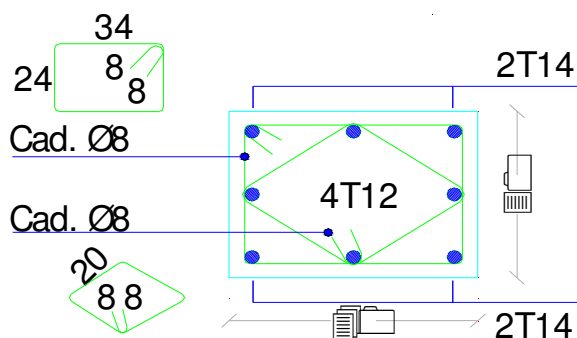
Coupe de ferrailage des poteaux (30×40) cm²
